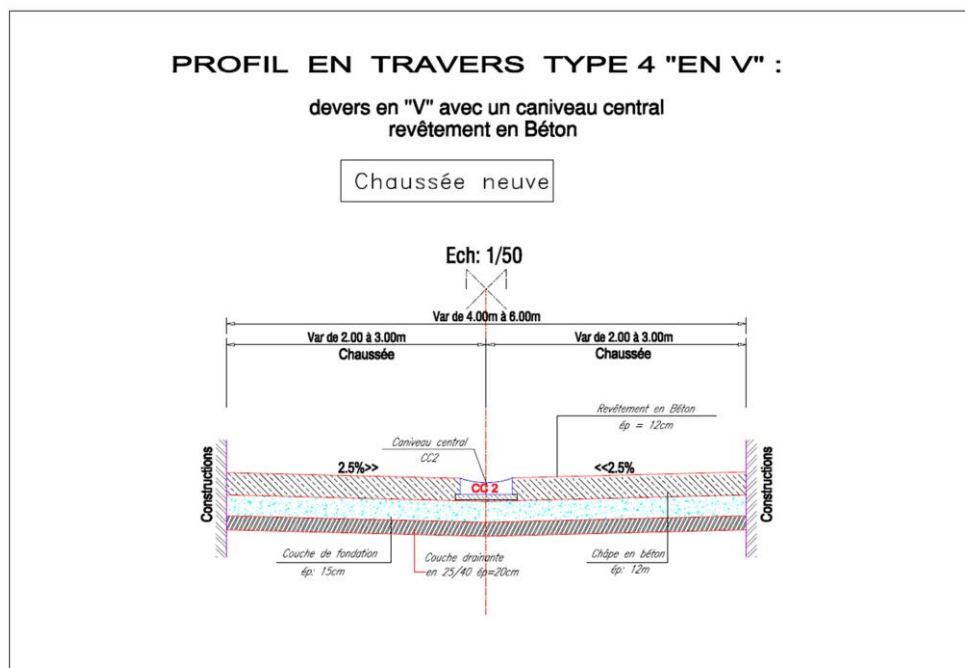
Coupe type du corps de chaussée-Aménagement type 4
